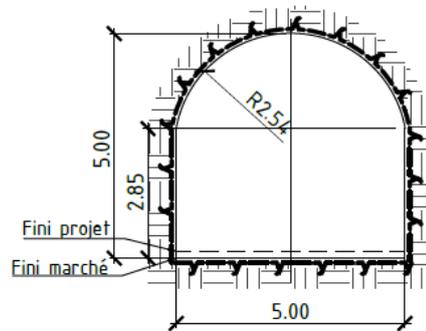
Section type finies de la galerie GAREX - échelle 1/125
